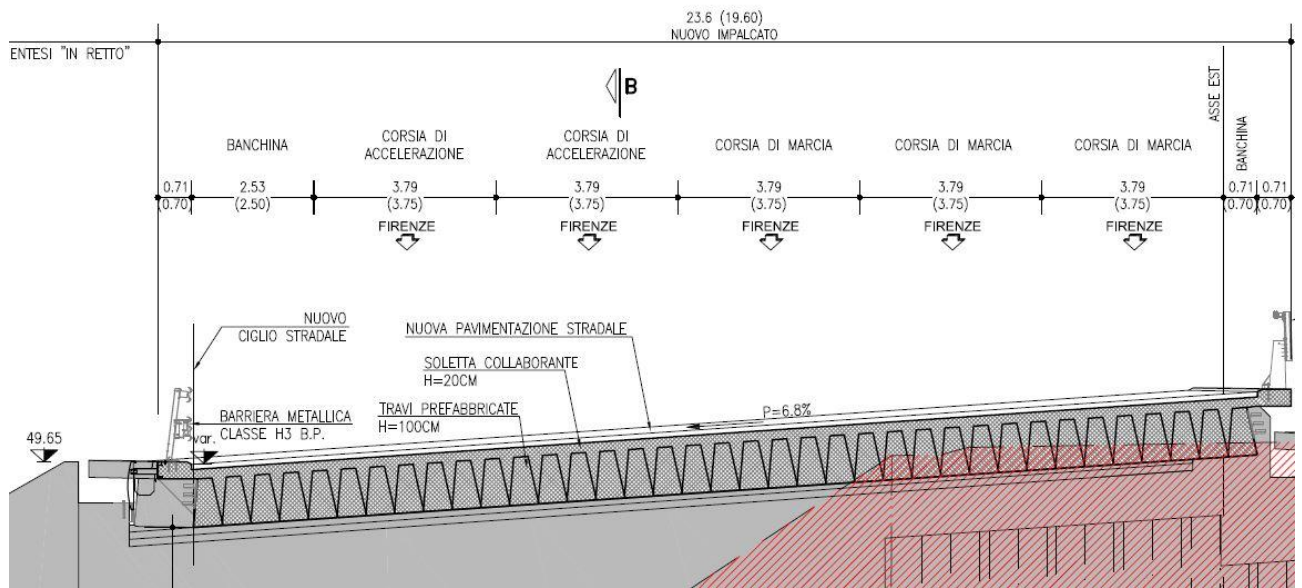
Sezione tipo struttura ampliamento sottovia.
